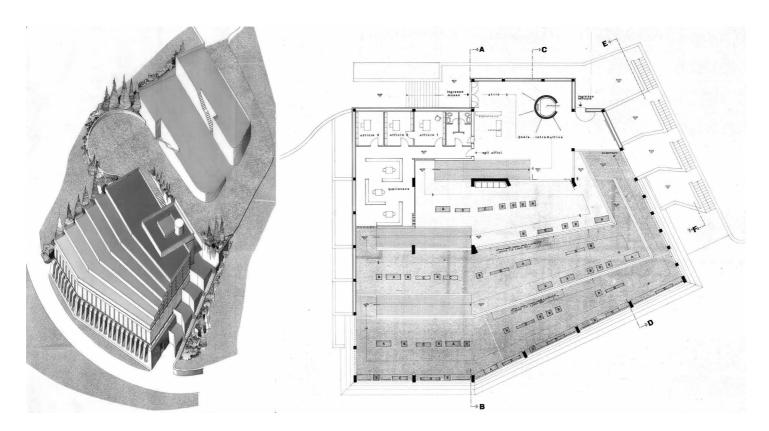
F. Minissi, Progetto dell'antiquarium di Himera a Termini Imerese. Vista assonometrica e pianta a quota +48,20 (Collezione privata, Palermo).
